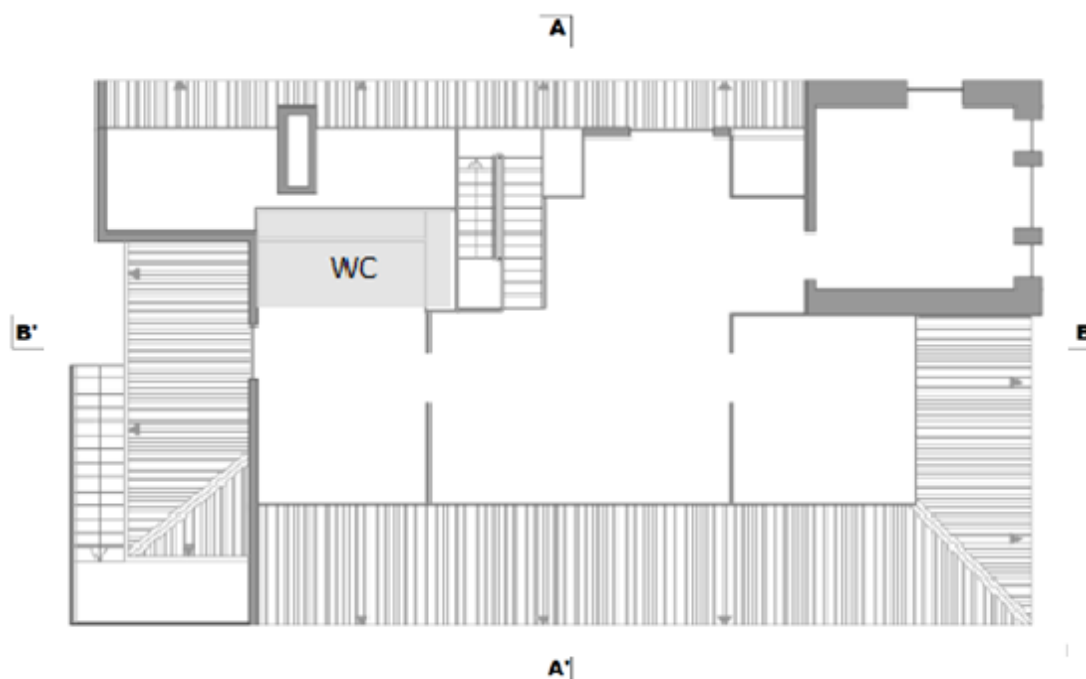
Planta do piso 2 com a área delimitada para a instalação do módulo sanitário
